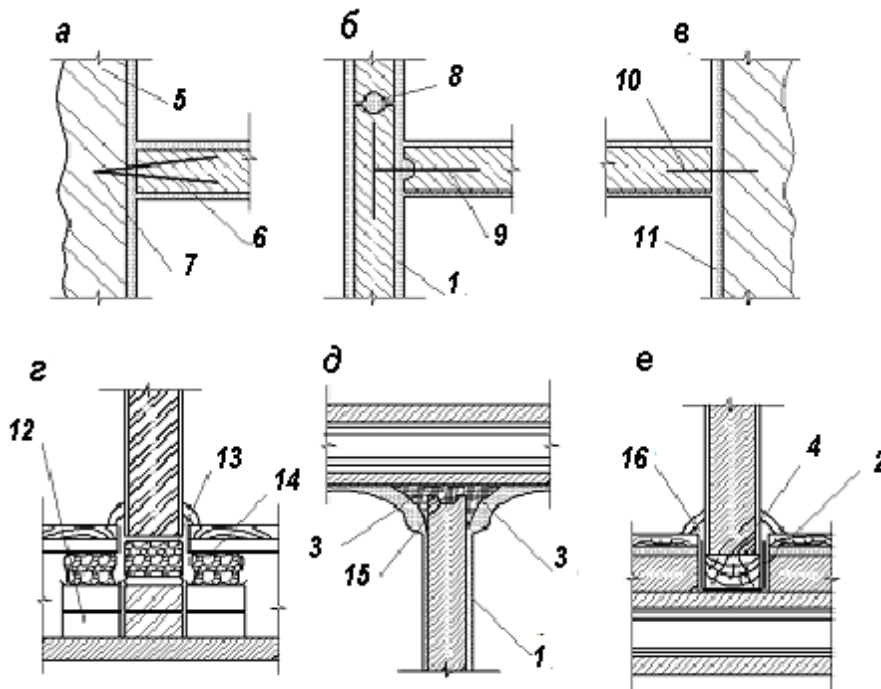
Кріплення перегородок: а, б, в – прилягання до стін із кріпленням відповідно дротом, анкерами і штирями; г, е – спирання перегородок (крім столярних) на перекриття; д – прилягання перегородки до стелі з кріпленням брусками; 1 – затирання; 2 – рулонний матеріал; 3 – трикутні бруски; 4 – дошка або брус; 5 – кам'яна стіна; 6 – дрiт; 7 – цвях; 8 – стик гіпсобетонних плит; 9 – анкер; 10 – штир; 11 – штукатурка; 12 – цегляний стовпчик; 13 – лежень; 14 – лага; 15 – конопатка; 16 – пружна прокладка
